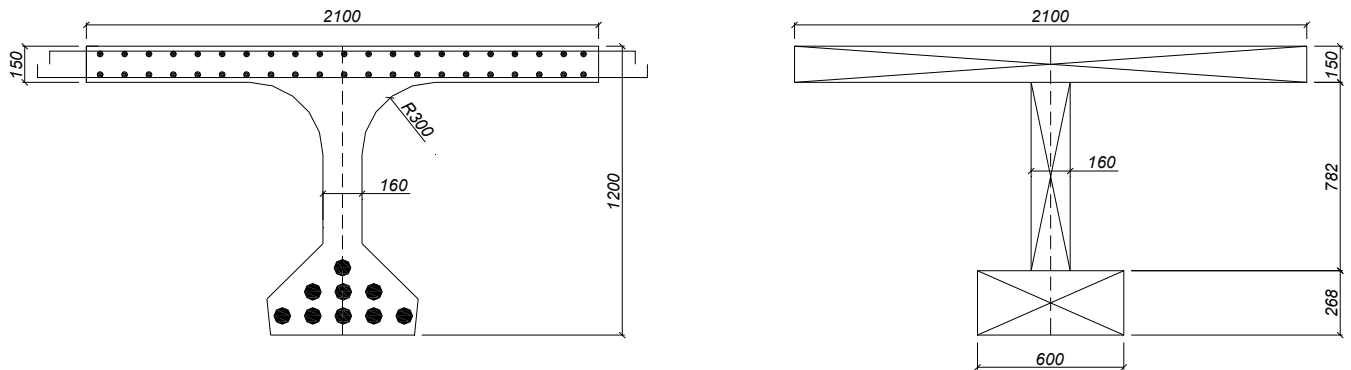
Поперечний переріз балки прогонової будови
